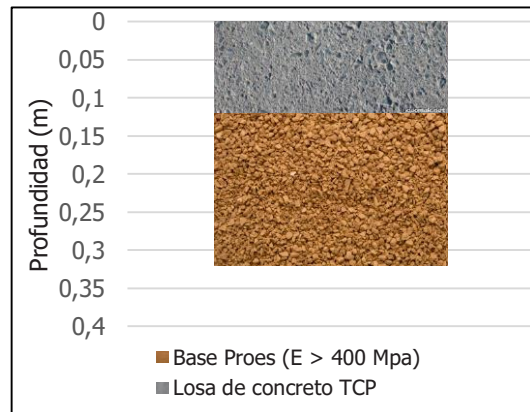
Estructura de pavimento en Proyecto La Fazenda, Puerto Gaitán
